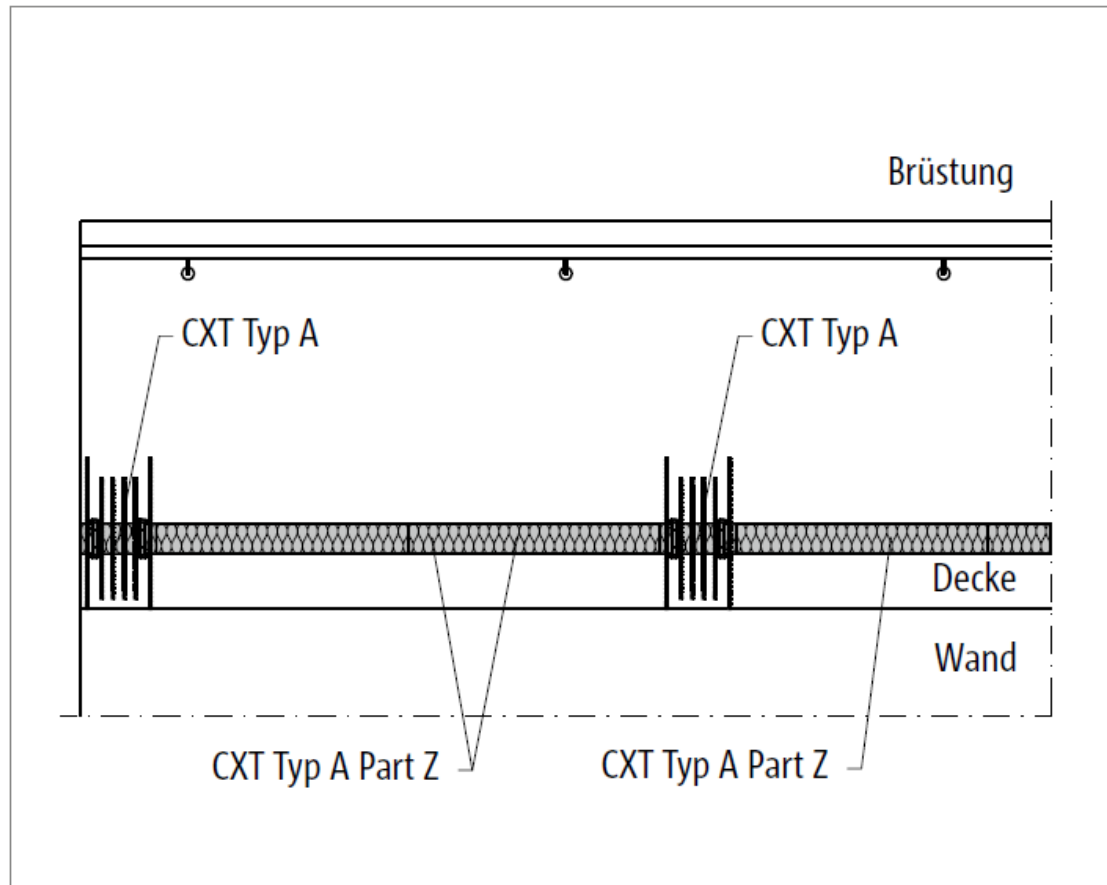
Schöck Isokorb® CXT Typ A und CXT Typ Part Z: Brüstung
